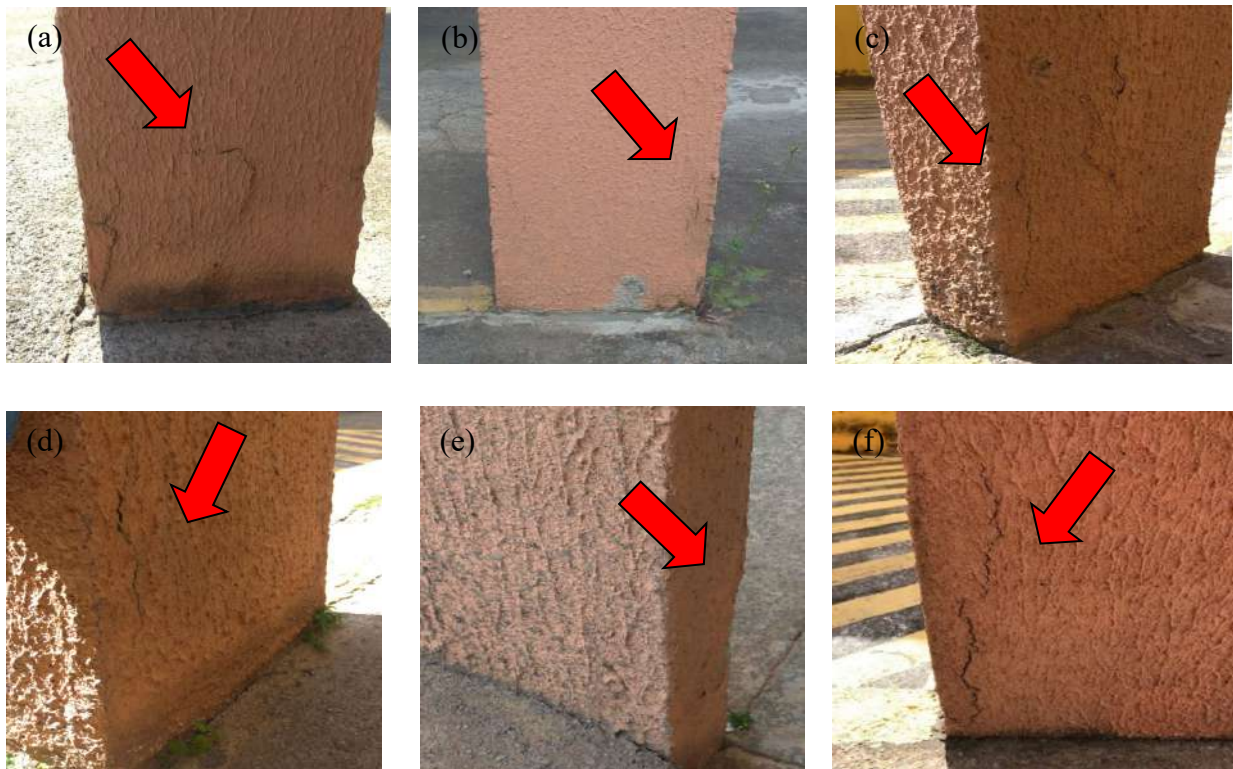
(a) Pilar 05, (b) Pilar 06, (c) Pilar 19, (d) Pilar 38, (e) Pilar 46, (f) Pilar 47.
